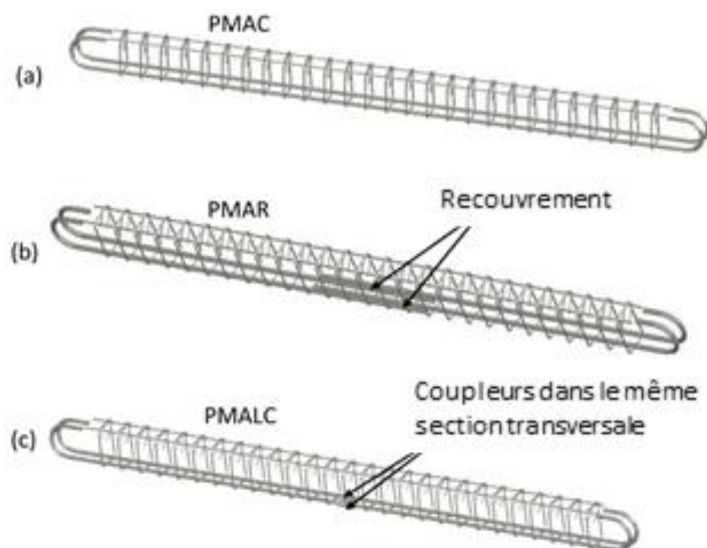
Géométrie des armatures utilisées pour les différentes poutres. (a) Poutre avec armatures continues (PMAC). (b) Poutre avec armatures de recouvrement (PMAR). (c) Poutre avec coupleurs à mi-portée dans la même section transversale, les étriers ont la même distribution sur toute la poutre.
